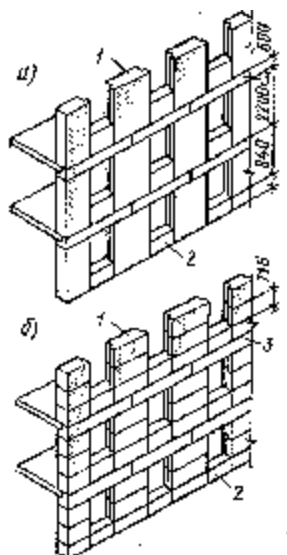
Схемы разрезки стен крупноблочных зданий: а – двухрядная; б – четырехрядная; 1 – простеночный блок; 2 – подоконный блок; 3 – блок-перемычка.
